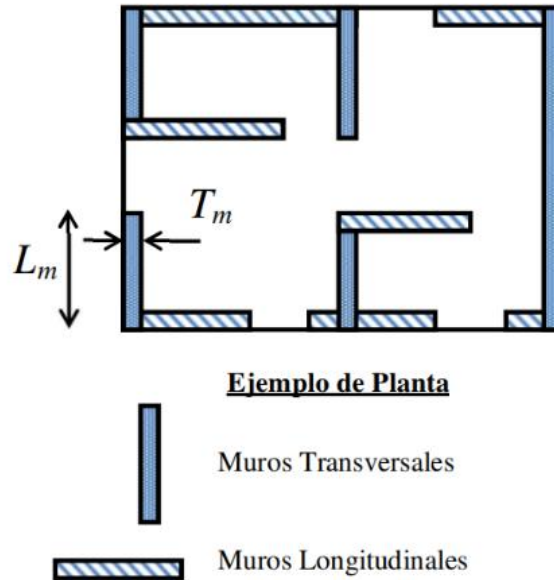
Ejemplo de planta para cálculo de PAM existente (BuildChange, 2015).
